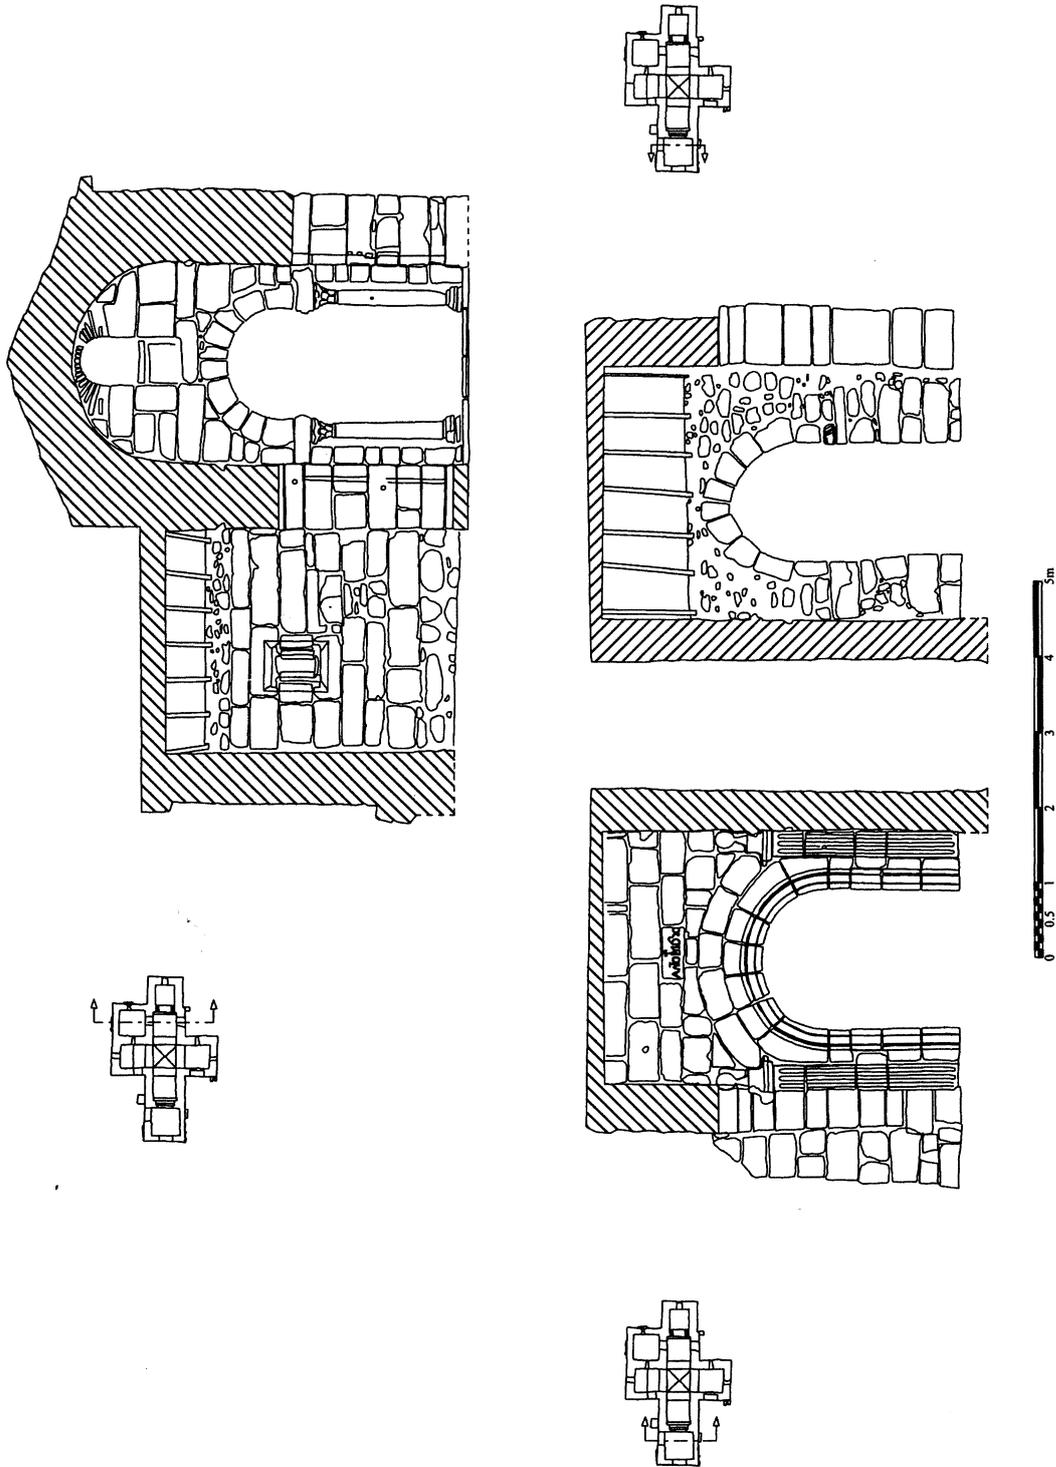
a y b. Alzado exterior O. y sección por el porche de Sta. Comba de Bande. E. 1/100.
